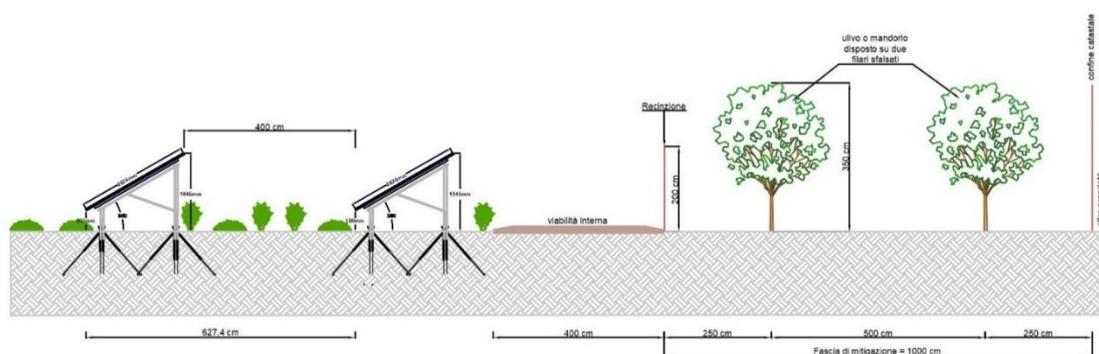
Area di mitigazione pianta e sezione trasversale e in pianta
